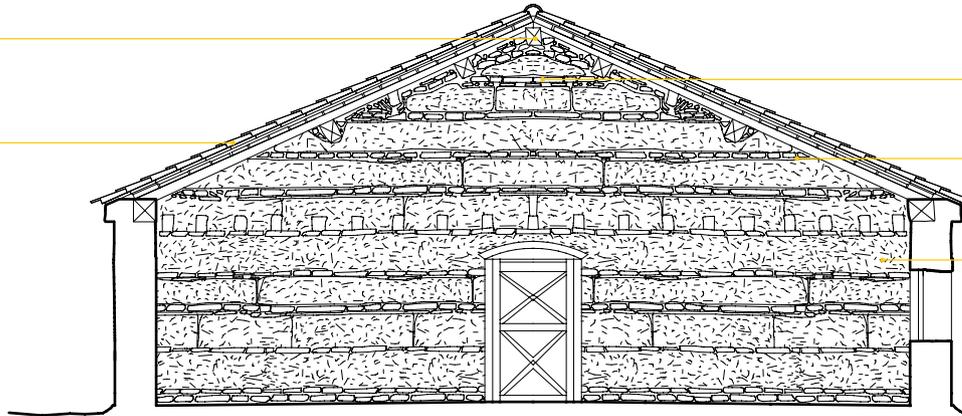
Corte de edifício em taipa reforçada, Beja Section of a building in reinforced Mammed-earth, Beja
